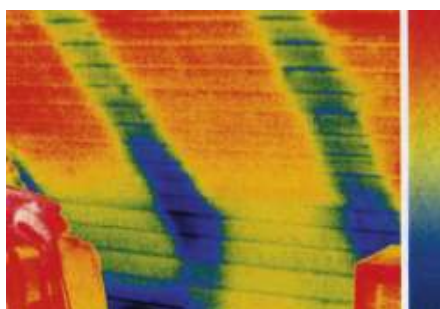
Mostki termiczne przez drewnianą konstrukcję dachu (więźbę), widoczne w miejscach topnienia śniegu.
